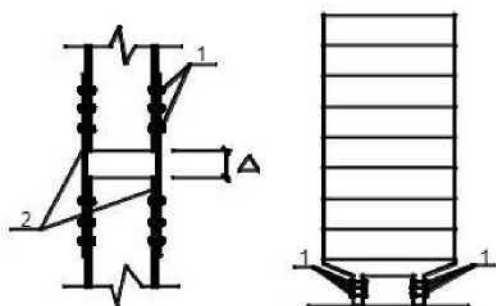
Здание с первым гибким этажом: 1 - болты; 2 - накладки
